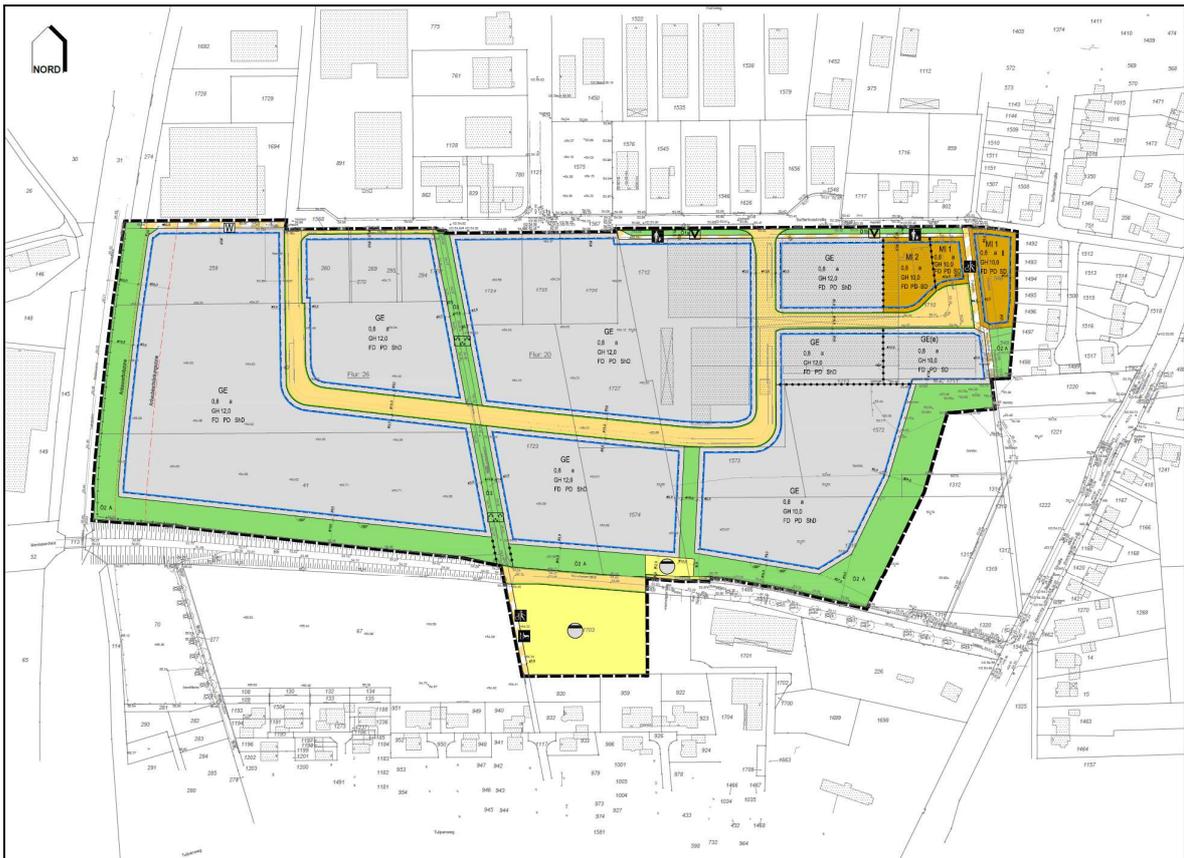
Entwurf der Planzeichnung zum Bebauungsplan Bra/12c „Gewerbegebiet Holtweg Süd“
